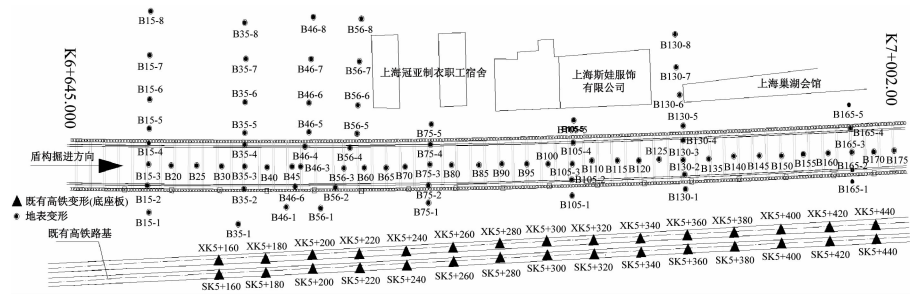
机场联络线并行高铁路基盾构施工段监测点平面布置示意图
